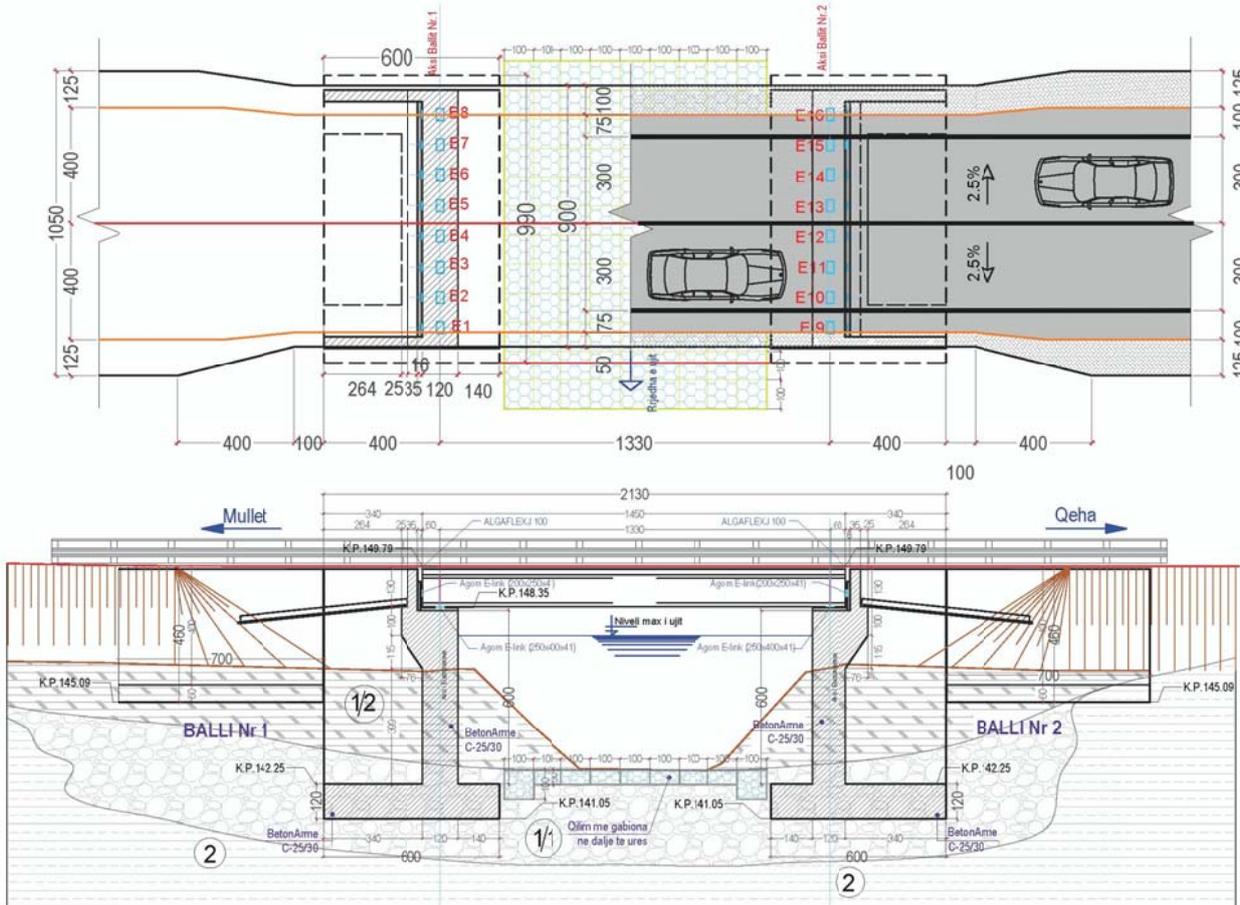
Planimetria dhe Prerja gjatësore e Urës
